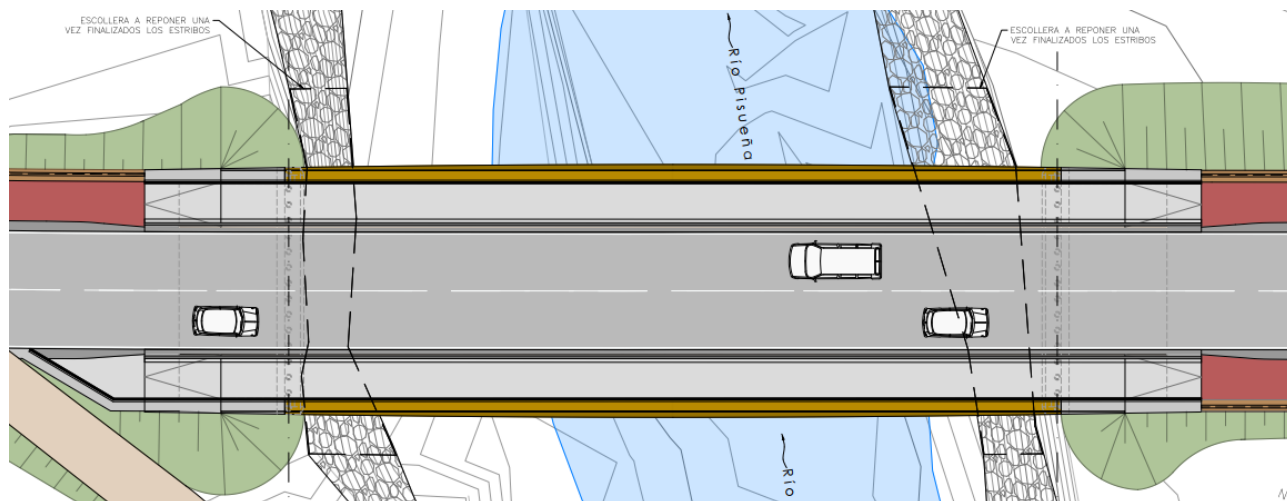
Planta del nuevo puente sobre el río Pisueña.
